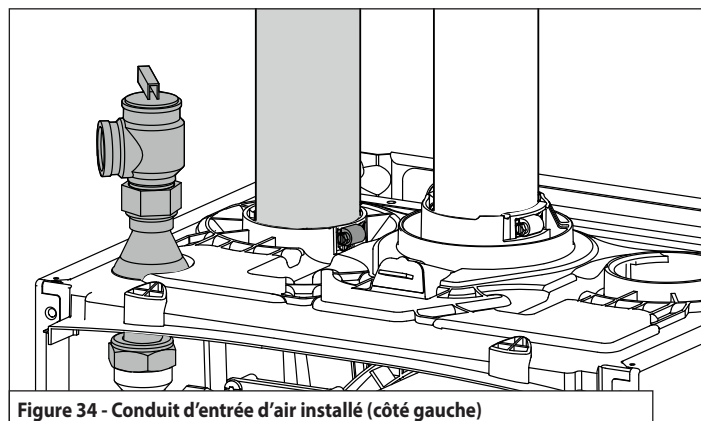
Conduit d'entrée d'air installé (côté gauche)
